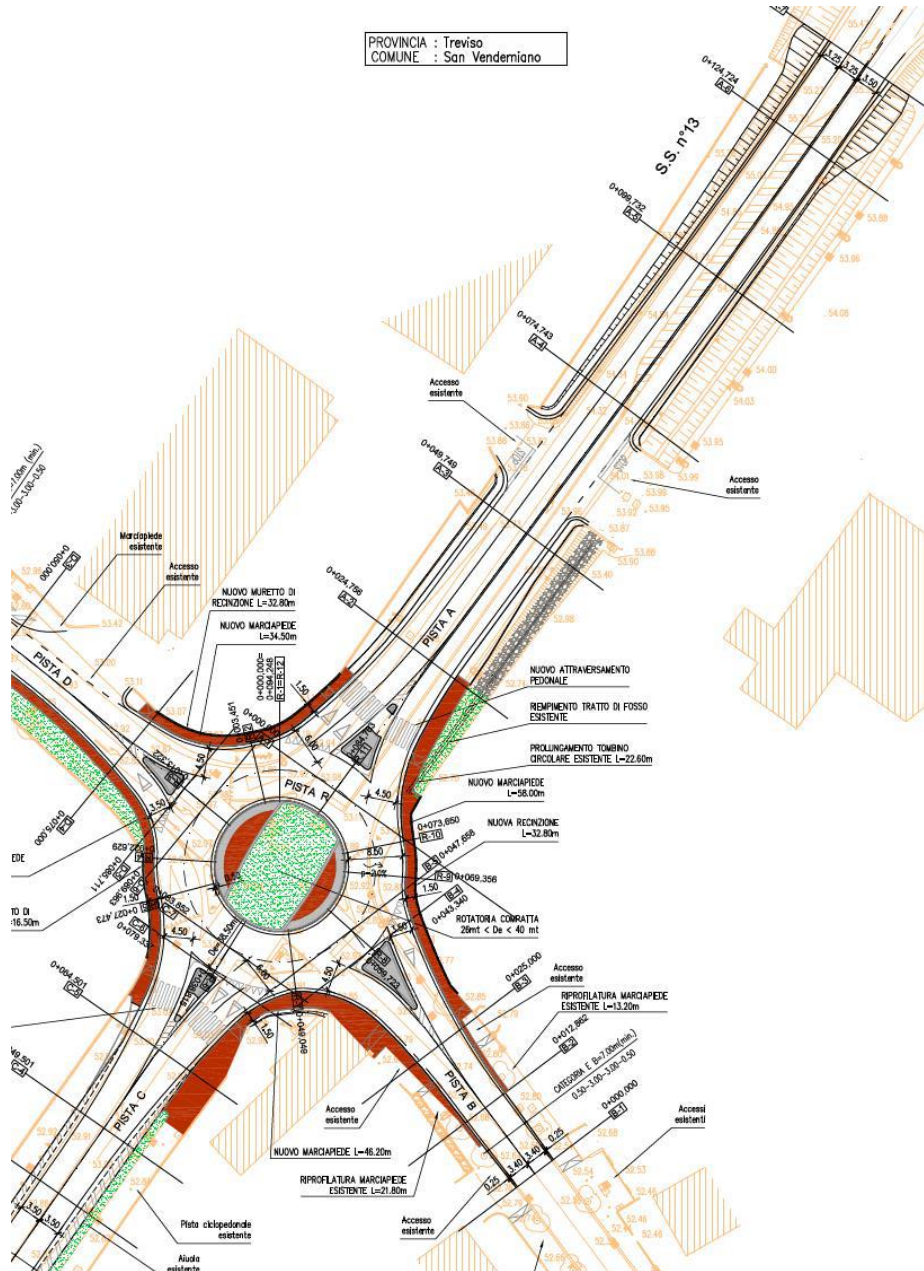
Estratto planimetrico rotatoria e riqualificazione tracciato S.S. n. 13
